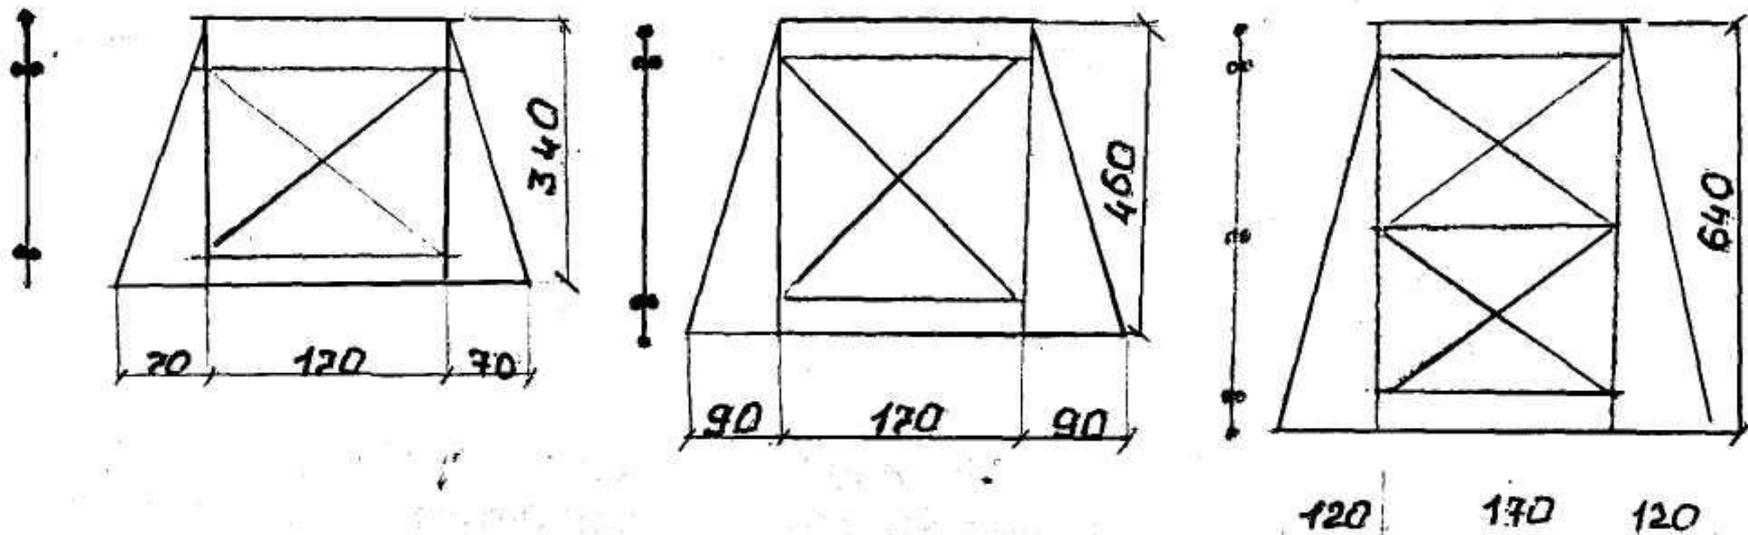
Схемы блоков надстроек из стандартных рам из круглого леса.
